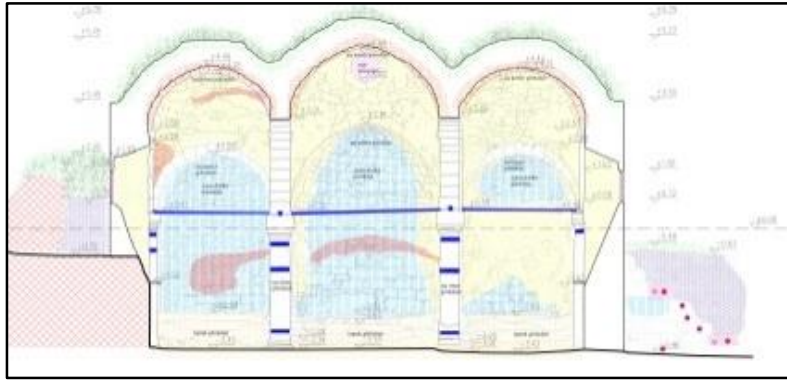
Hasar Tespit Çalışmaları Lejantı ve Plan, Cephe Çizim Örnekleri
